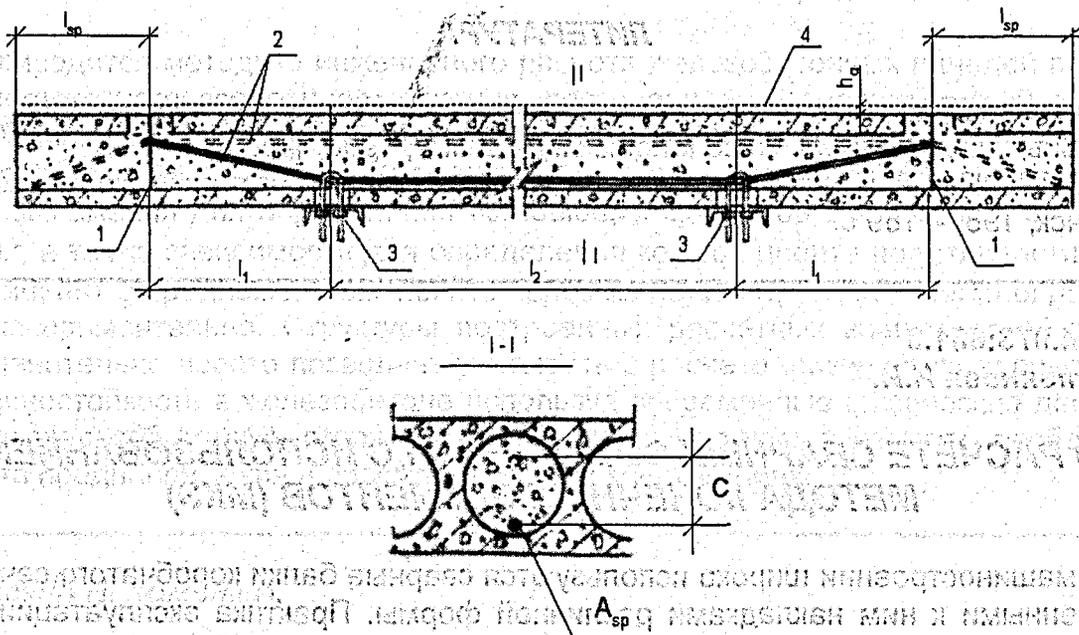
Способ усиления железобетонной многопустотной панели перекрытия дополнительной предварительно напрягаемой арматурой
